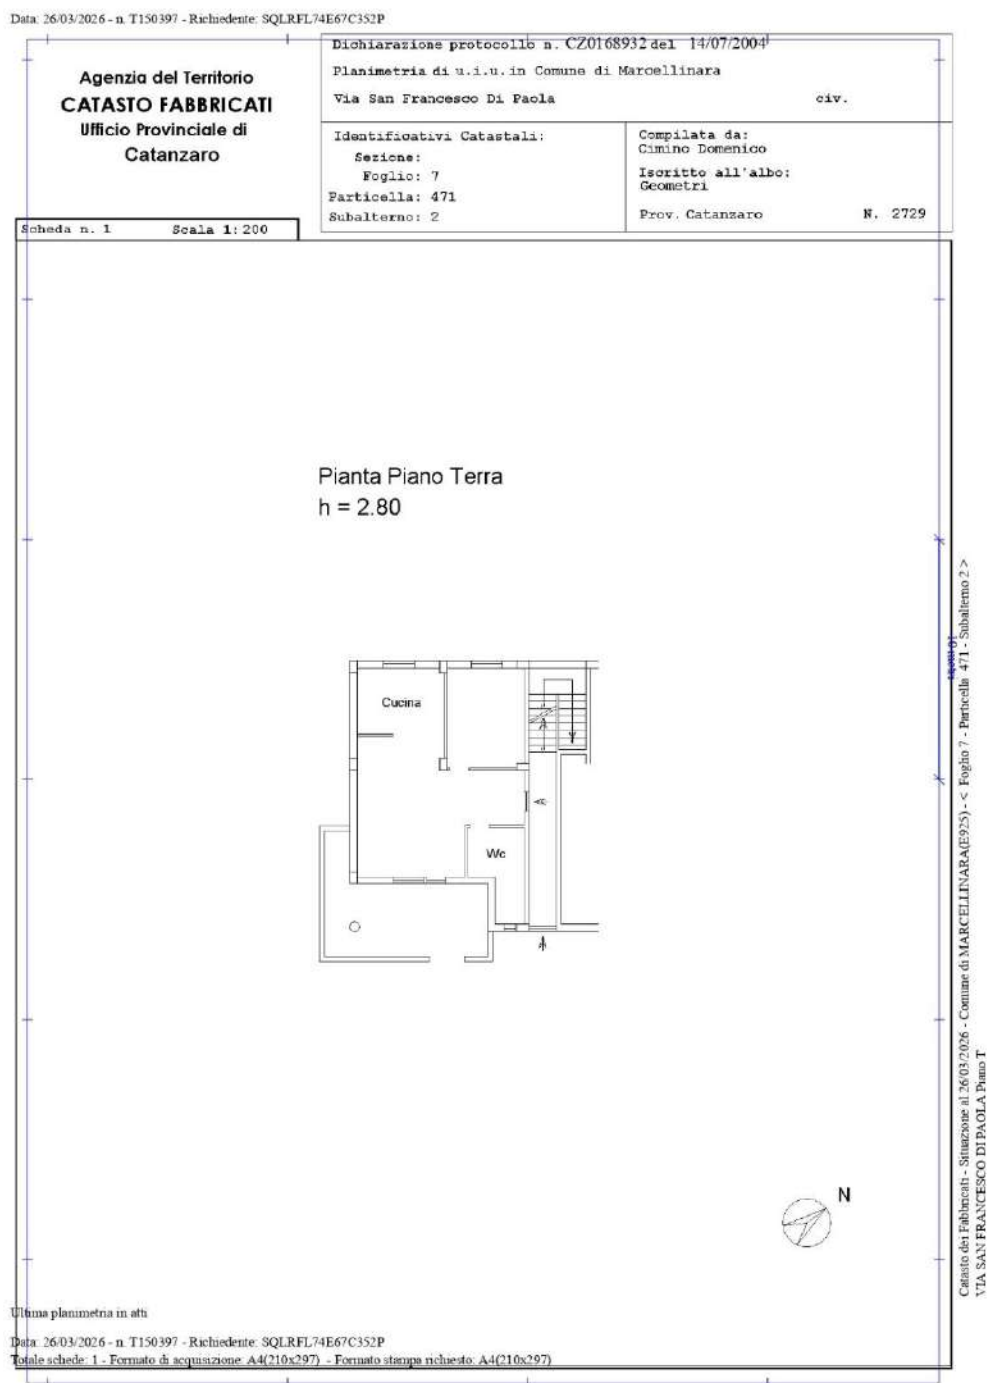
Ultima planimetria catastale in atti Fg.7 Part. 471 Sub. 2 Piano Terra [ALL. 3A]
